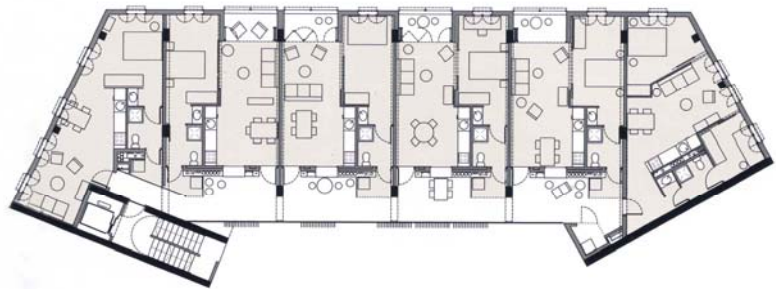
Emiliano López y Mónica Rivera. 27 viviendas de VPO en calle Sant Adrià, Barcelona. Planta
